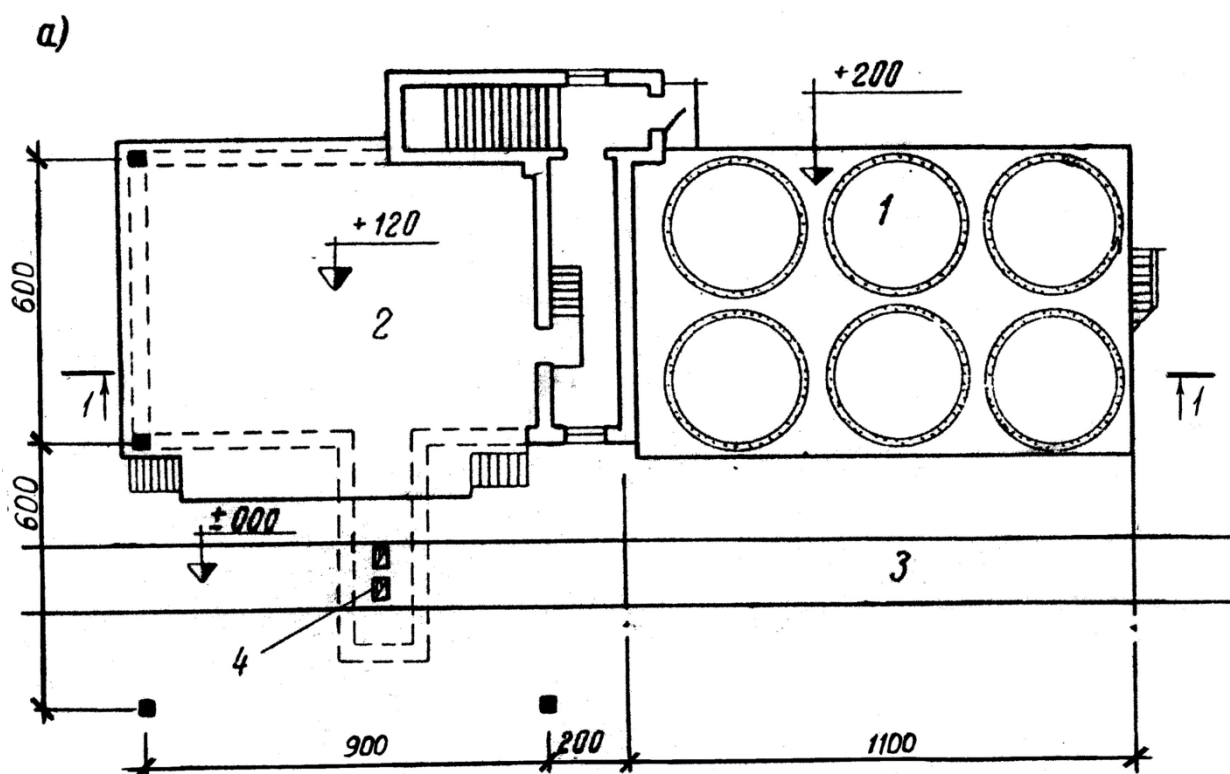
Схема плана склада цемента емкостью 300 т. (пунктиром показаны стены подвала): 1 – железобетонные силосы; 2 – навес для разгрузки цемента из вагонов; 3 – железнодорожный путь; 4 – люки для разгрузки цемента из специальных вагонов;
